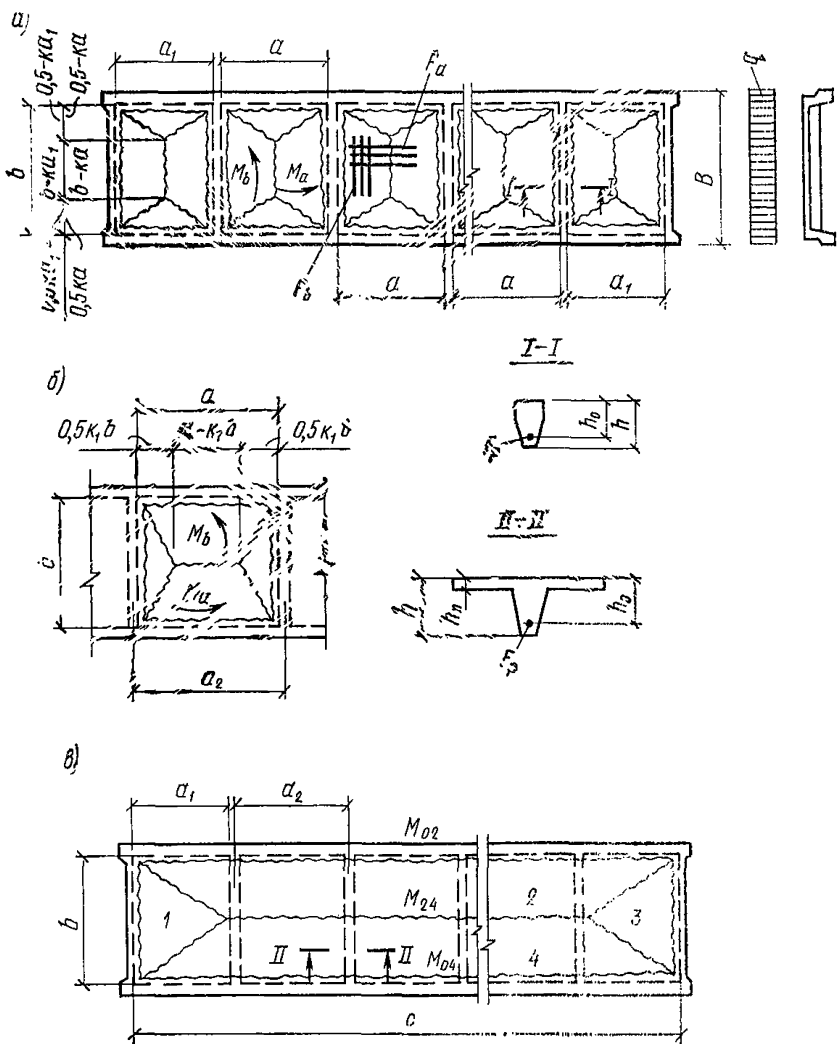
Схемы разрушения полки и поперечных ребер плит от изгиба и продольных ребер от кручения
